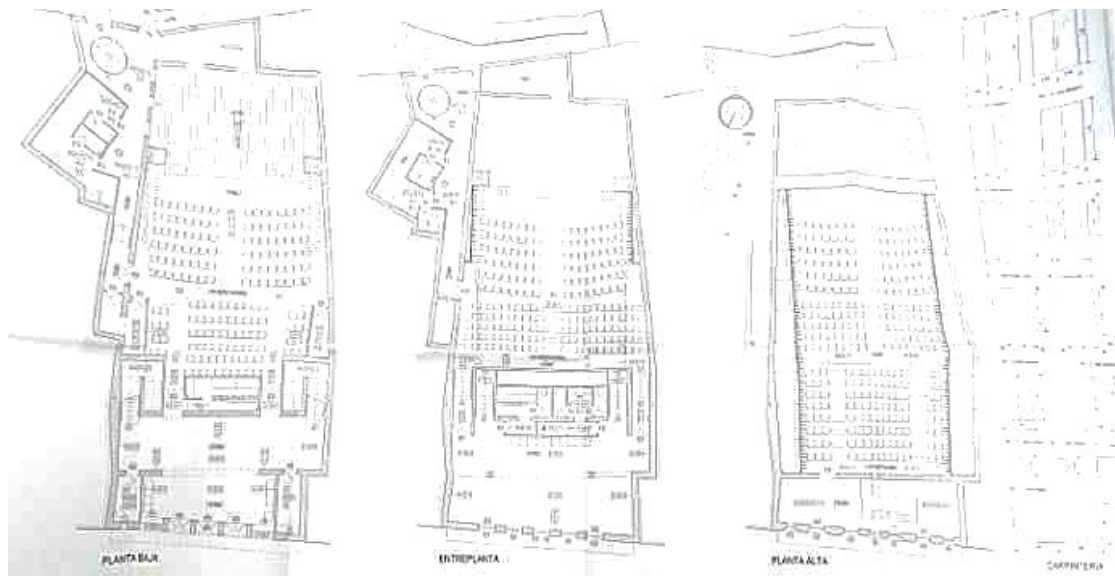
Planta baja, entreplanta y alta reformadas en la II Fase (PRIETO FERNÁNDEZ, J., 2000).
